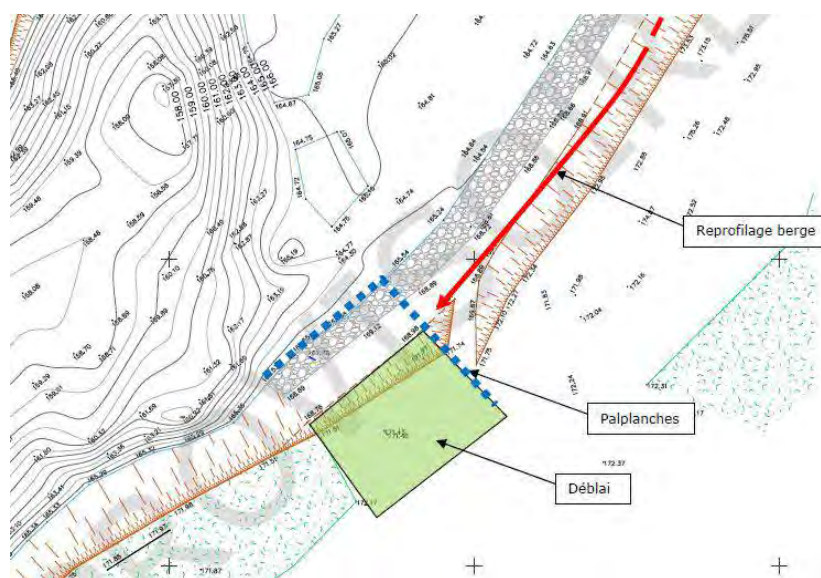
PROTECTION DE BERGE AU DROIT DE LA STATION D'ALERTE (PLAN MASSE)
